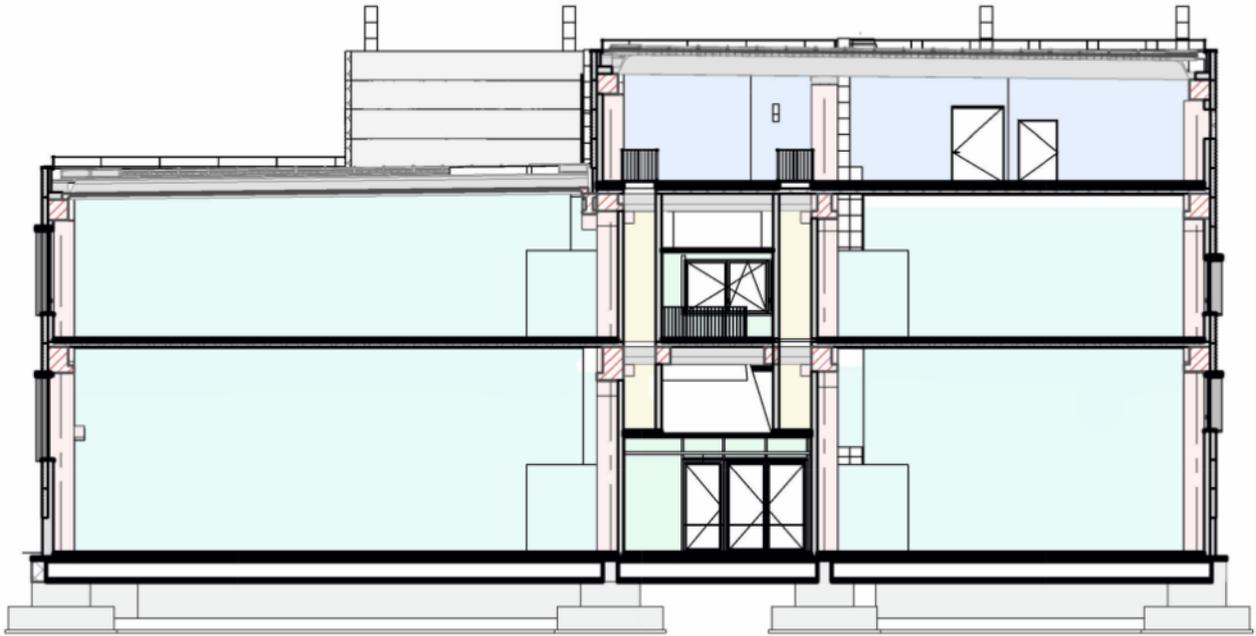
Sezione trasversale con dettaglio dei plinti di fondazione
